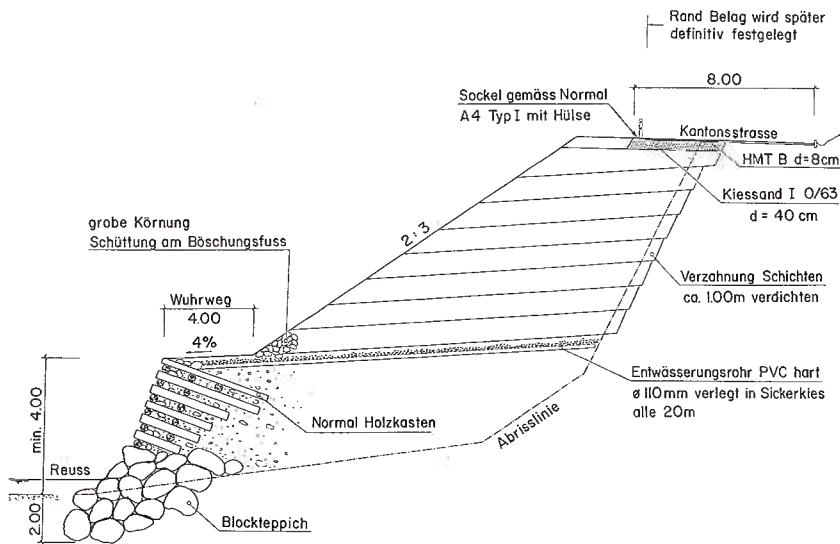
Ufersicherung mit Blockteppich als Fundament im Wasser gebaut; Krainerwand.
